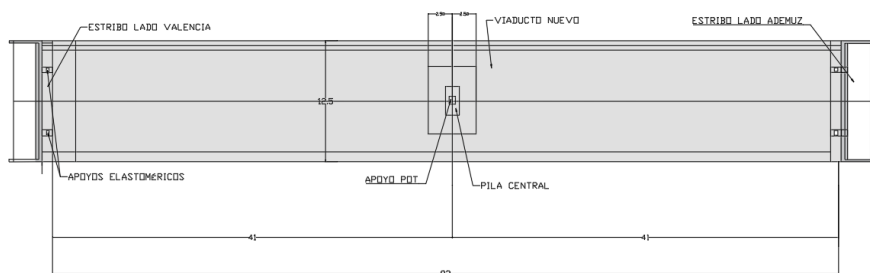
Vista en alzado de la estructura propuesta. Fuente: CAD de elaboración propia.
